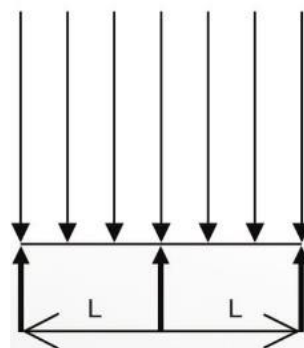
, Таблица 4. Нагрузки на кровельные панели с минераловатным утеплителем при схеме нагружения — статически неопределяемая двупролетная балка.
